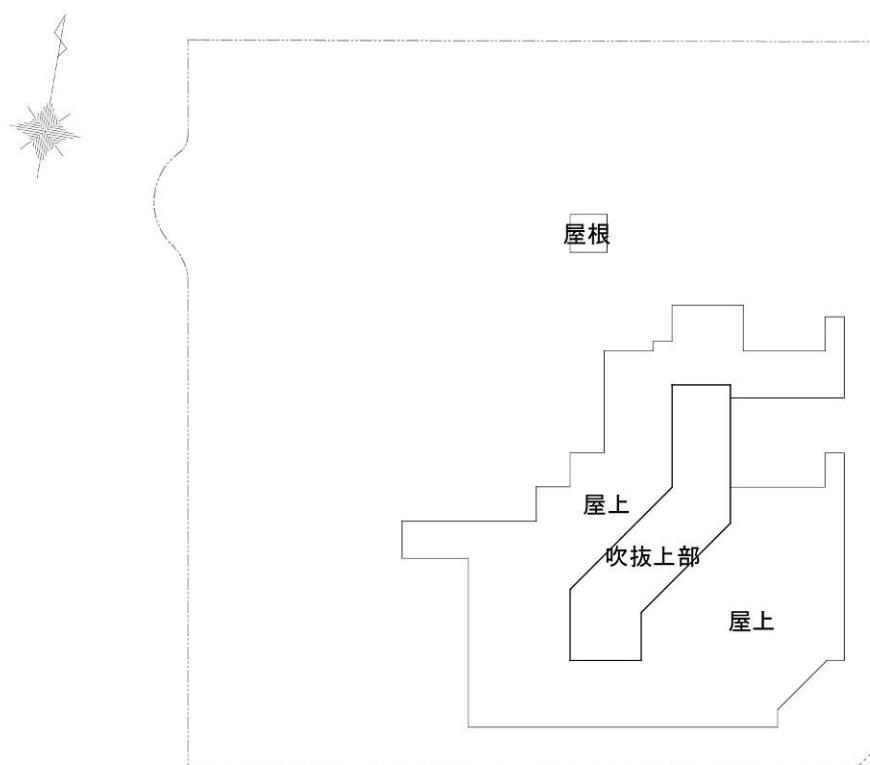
(5) 各階平面図(屋上階) 【変更後】
